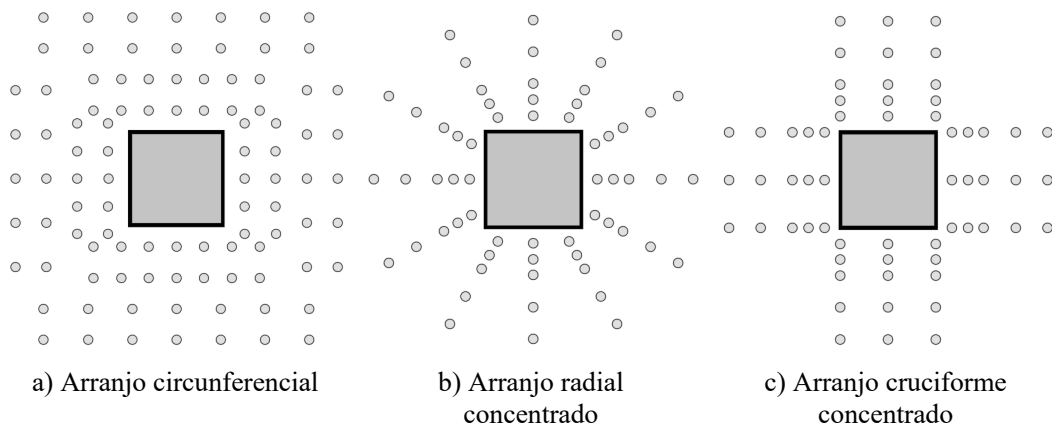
Arranjos de armadura de cisalhamento em ligações laje-pilar
